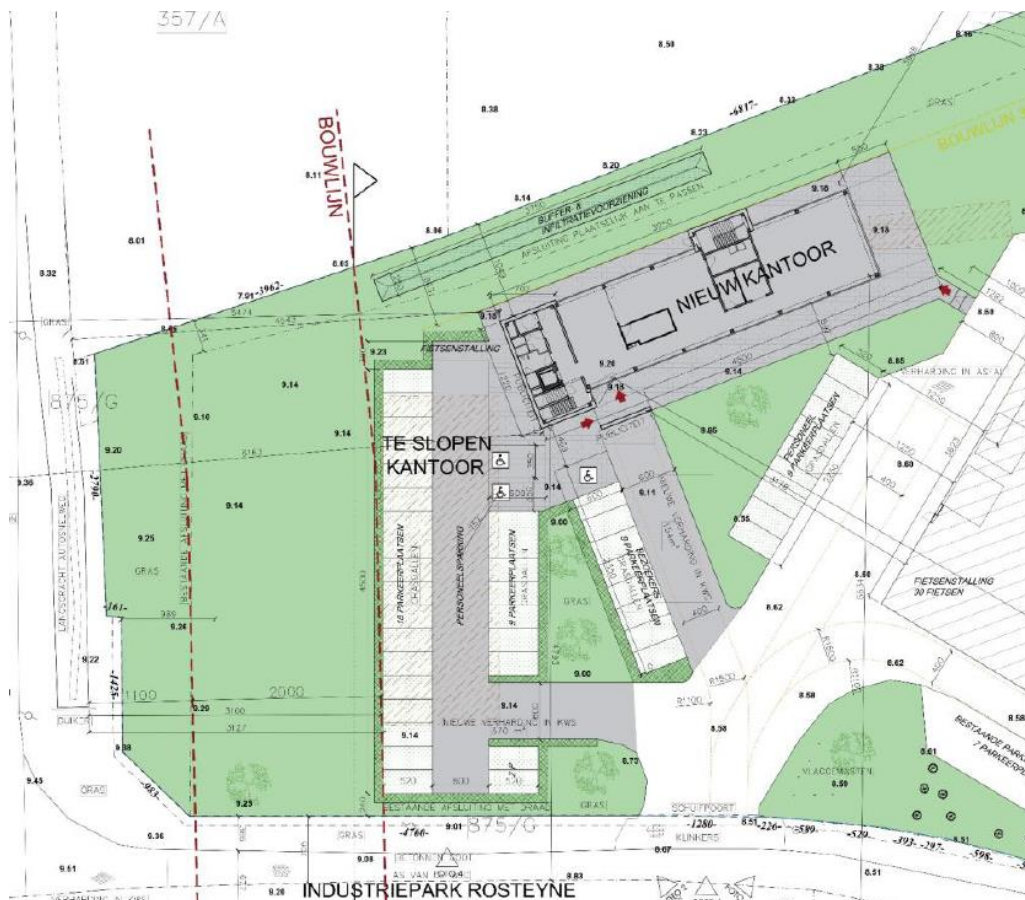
Inplantingsplan (@ Decramer & De Loof, bijlage 1).
